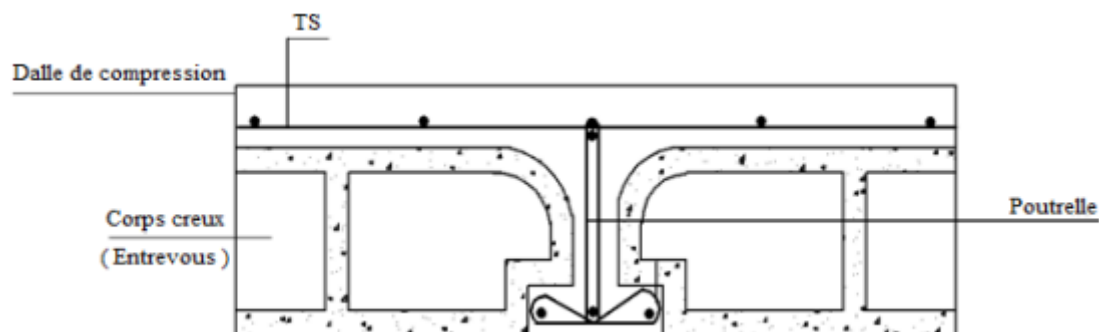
Coupe transversale d'un plancher à corps creux.
